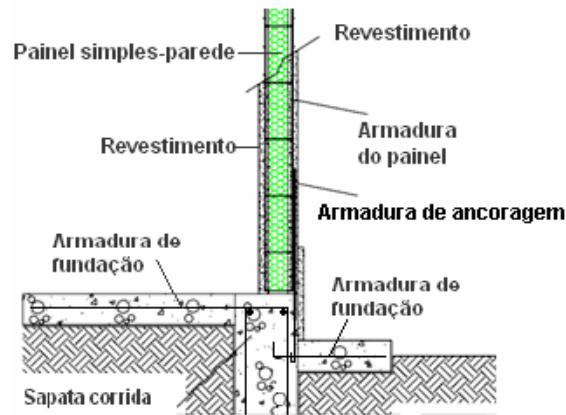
Detalhe de ancoragem do painel a fundação – parede externa
